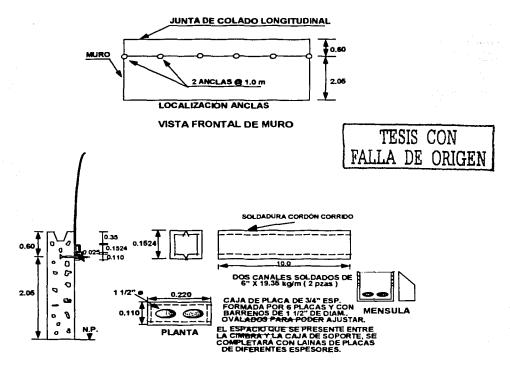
Mecanismo de apoyo para la coraza de la cimbra
